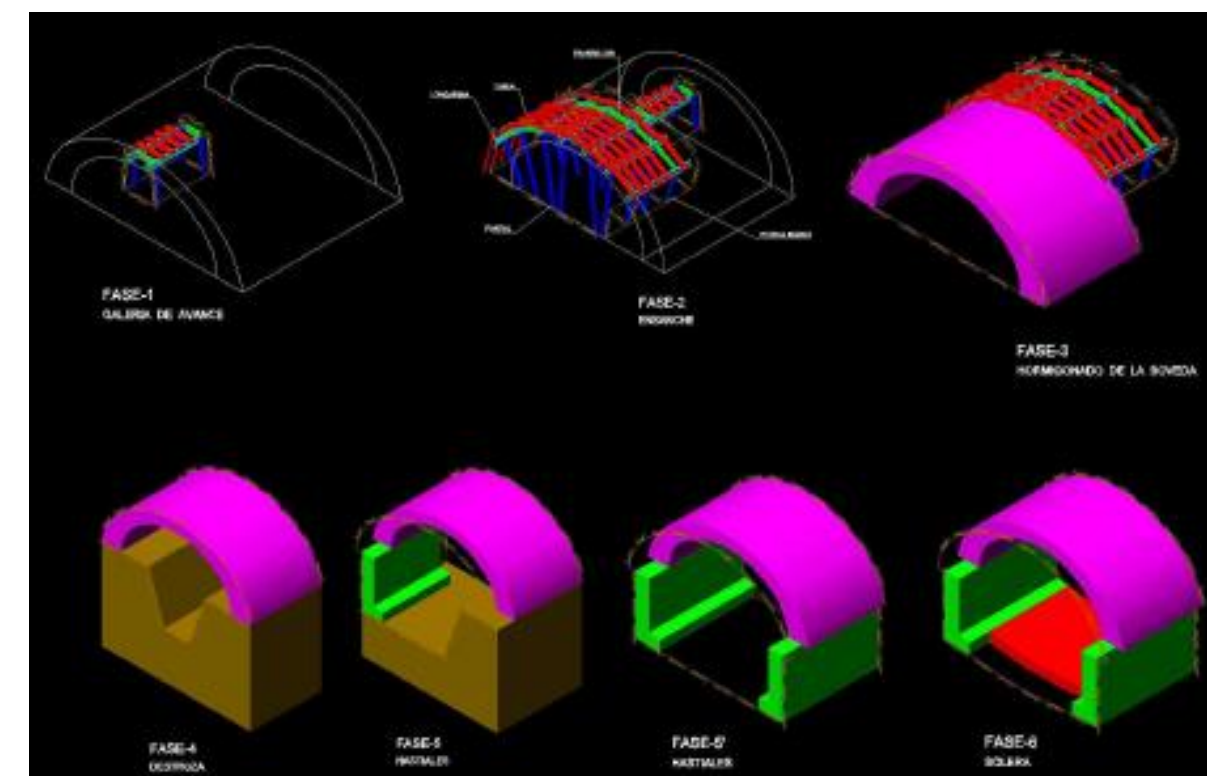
Fases constructivas habitualmente utilizadas en el Método Tradicional de Madrid.
